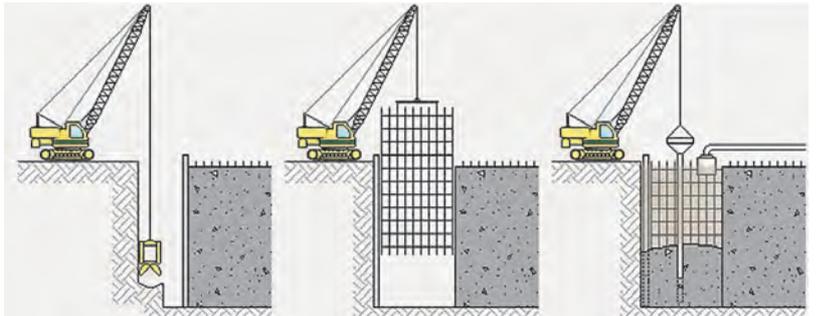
proceso de ejecución de muro pantalla de hormigón armado *in situ* con lodos.
